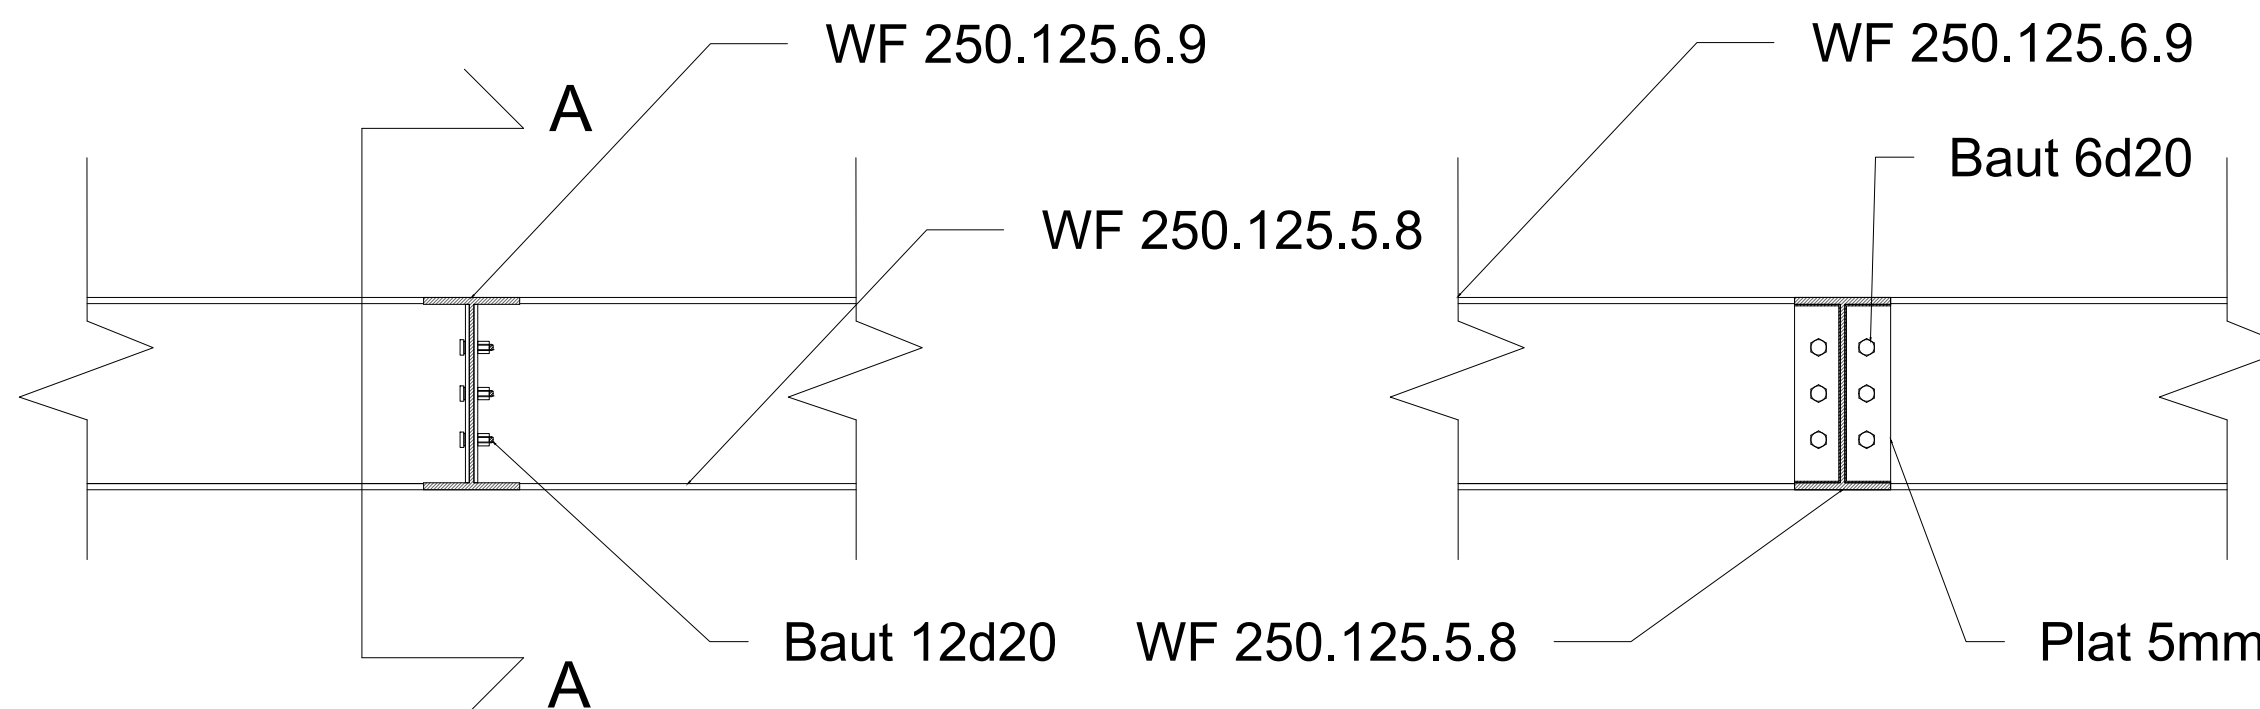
DETAIL SAMBUNGAN KOLOM - KOLOM
